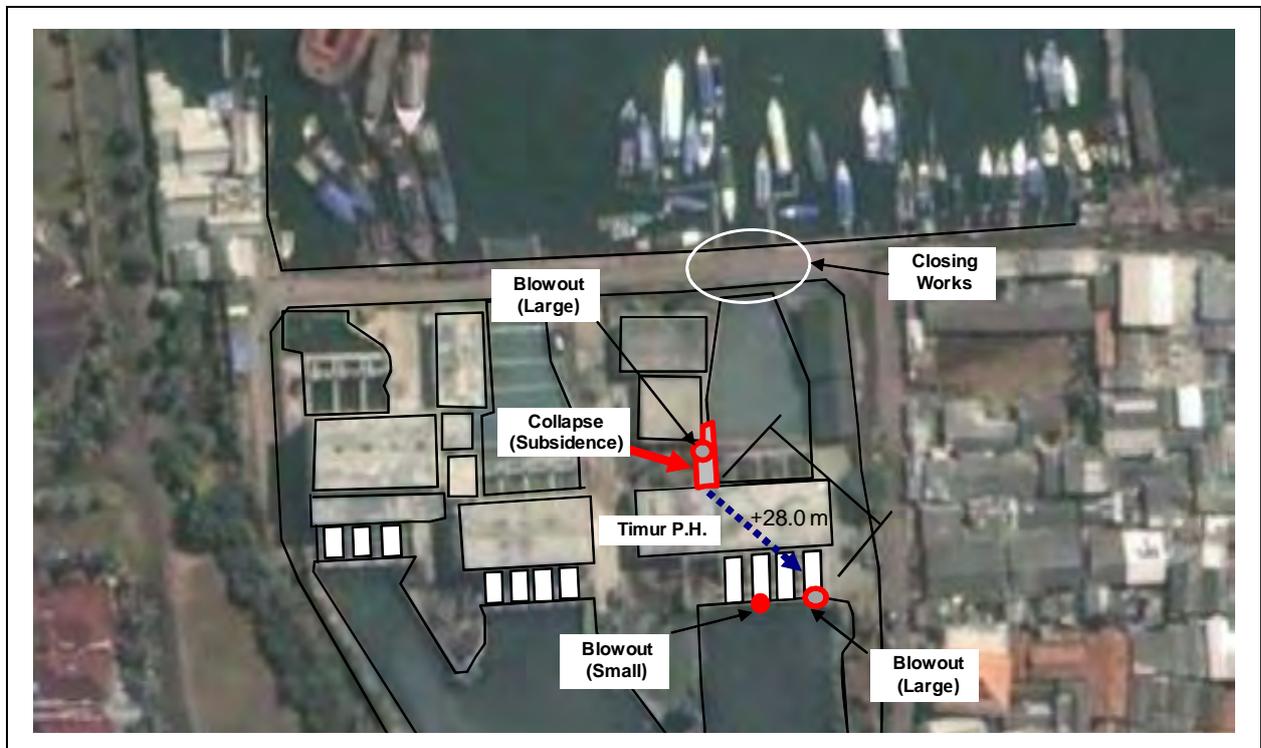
東ハウスのパイピング位置 (on 18/Feb/2009)
